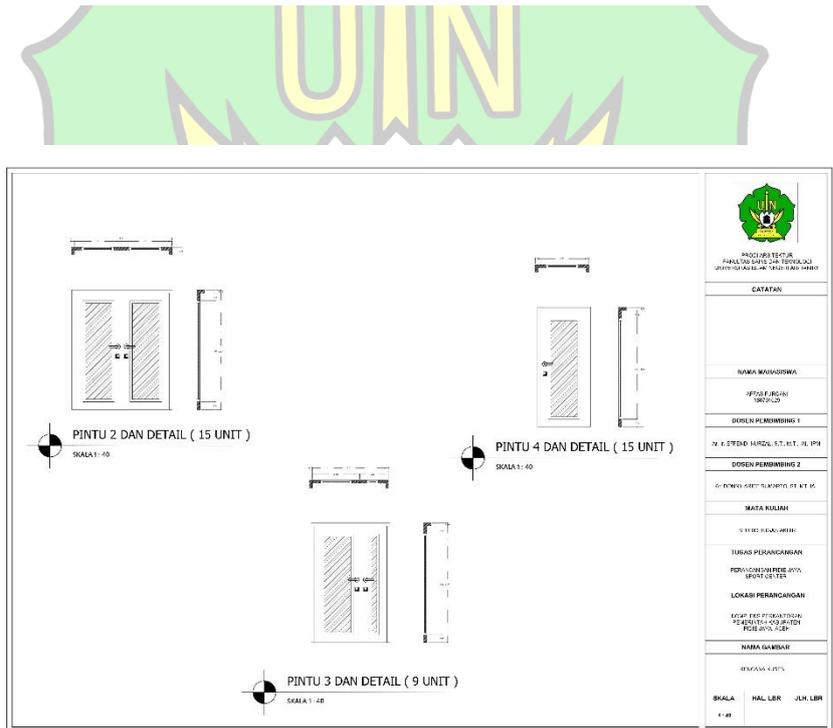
35 Denah Rencana Pintu Lantai 1 Gedung Utama
